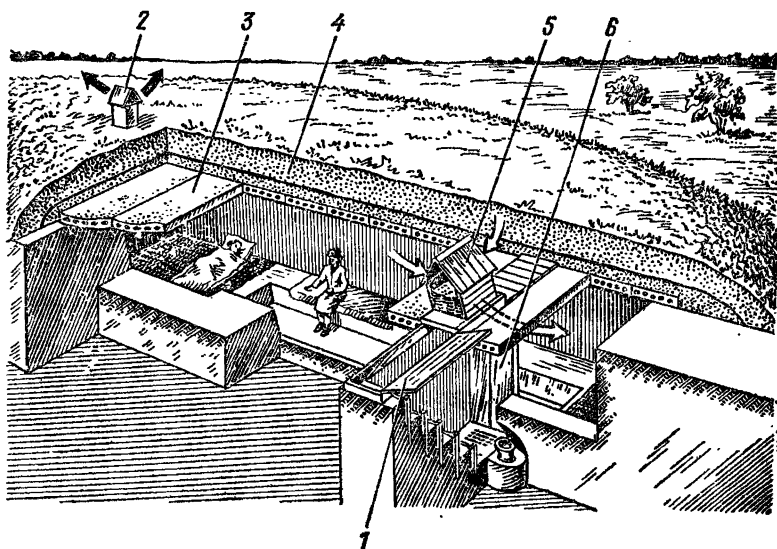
Противорадиационное укрытие с перекрытием из железобетонных плит:
